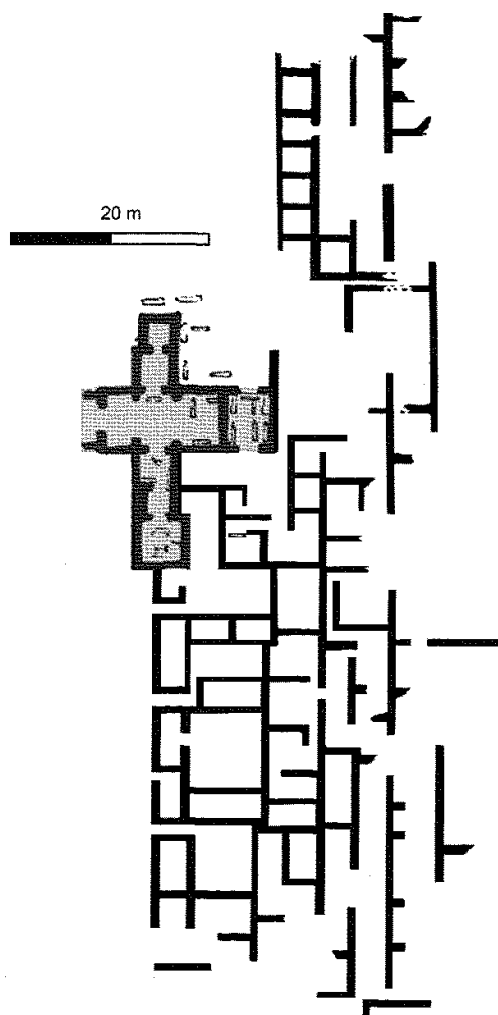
Planimetría de la *villa* Montinho das Laranjeiras (Alcoutim, Faro, Portugal).
